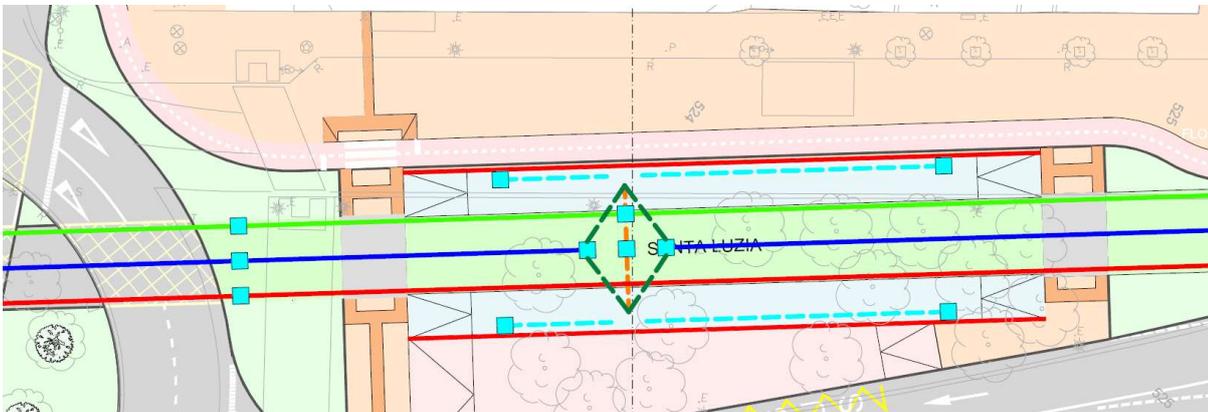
Canalización en parada - Proyecto Constructivo Ampliación a Salburua
